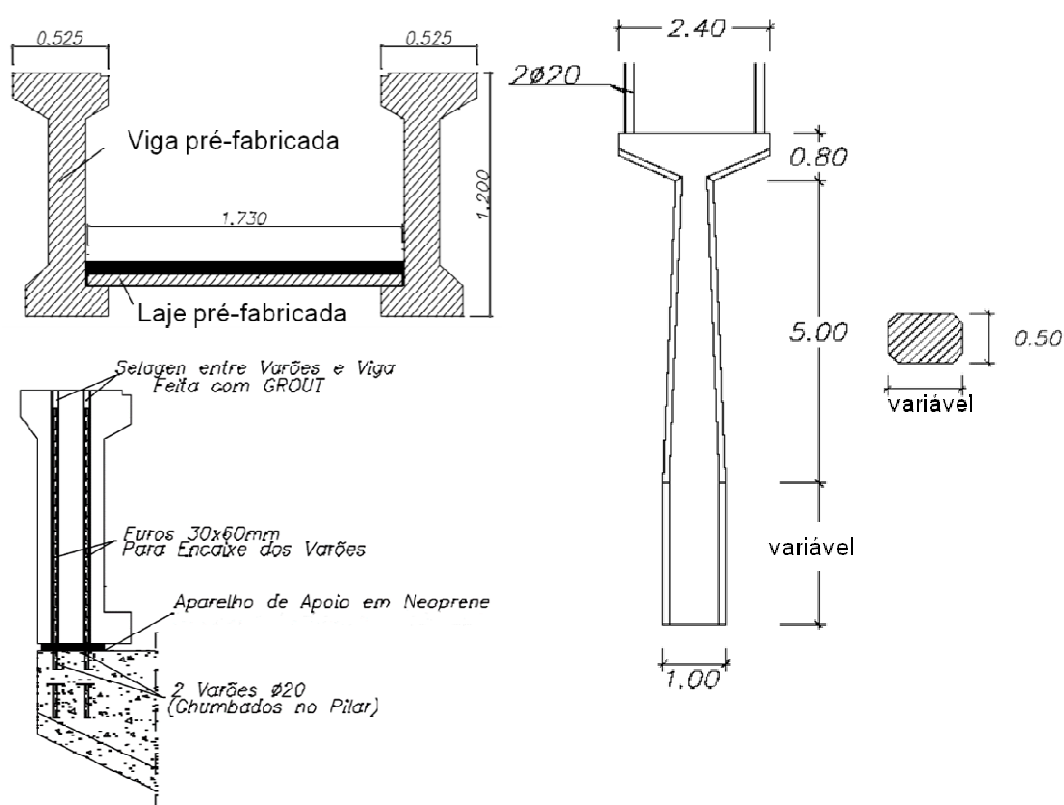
Caracterização geral dos elementos estruturais dos passadiços.
